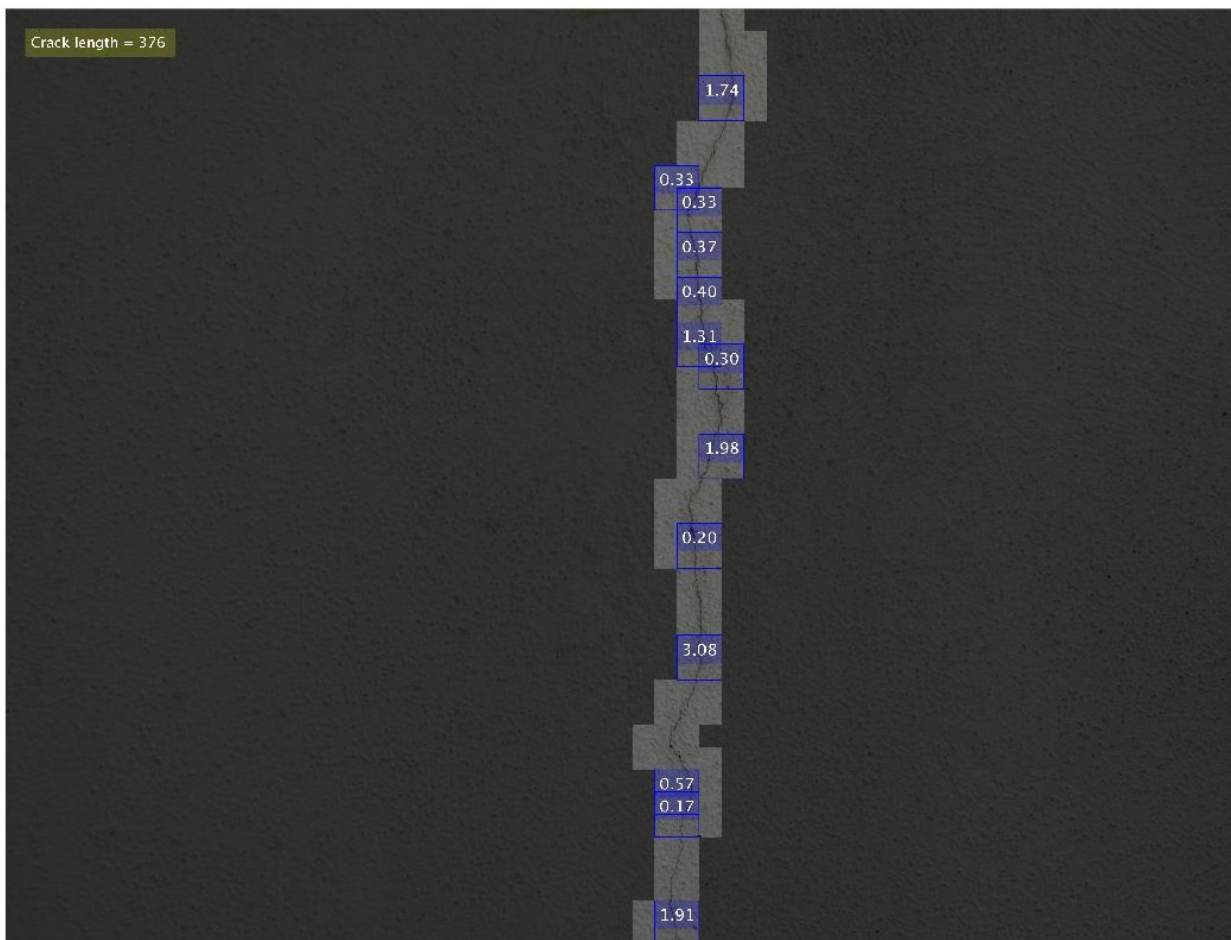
Detecção e caracterização da Fissura 3
